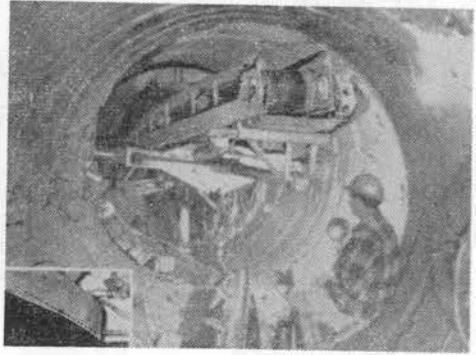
一時的に形を維持できる Detroit 粘土。曲線の施工も可能
